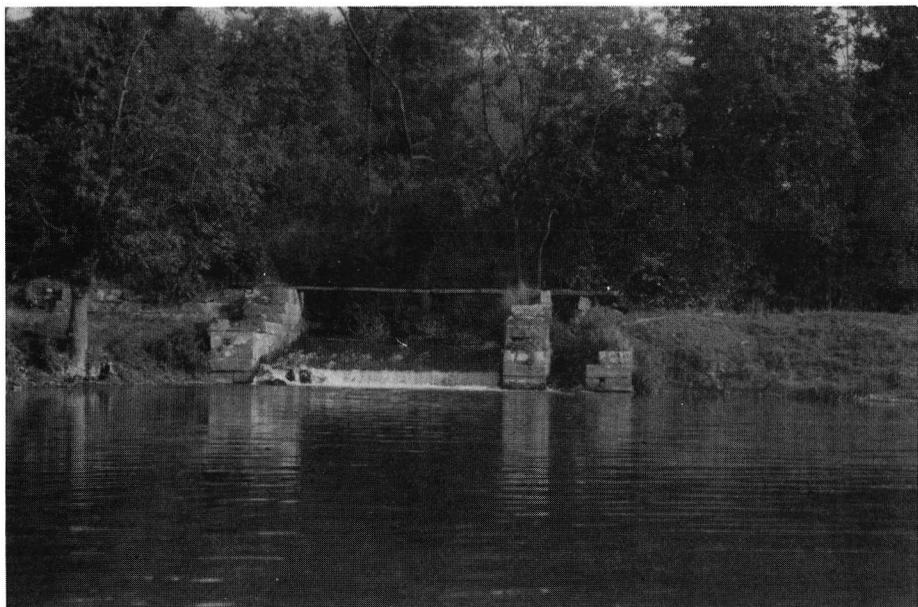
Barrage (n° 8 sur la figure 11) de Fallais. (Photo Jacques LOUIS).
